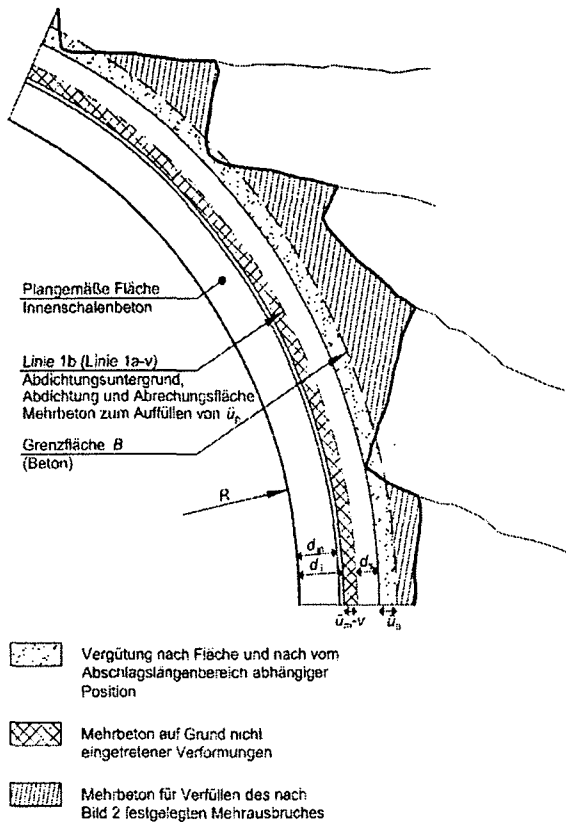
Abrechnungslinien; Beton und Mehrbeton – Darstellung nach der Verformung [139]
